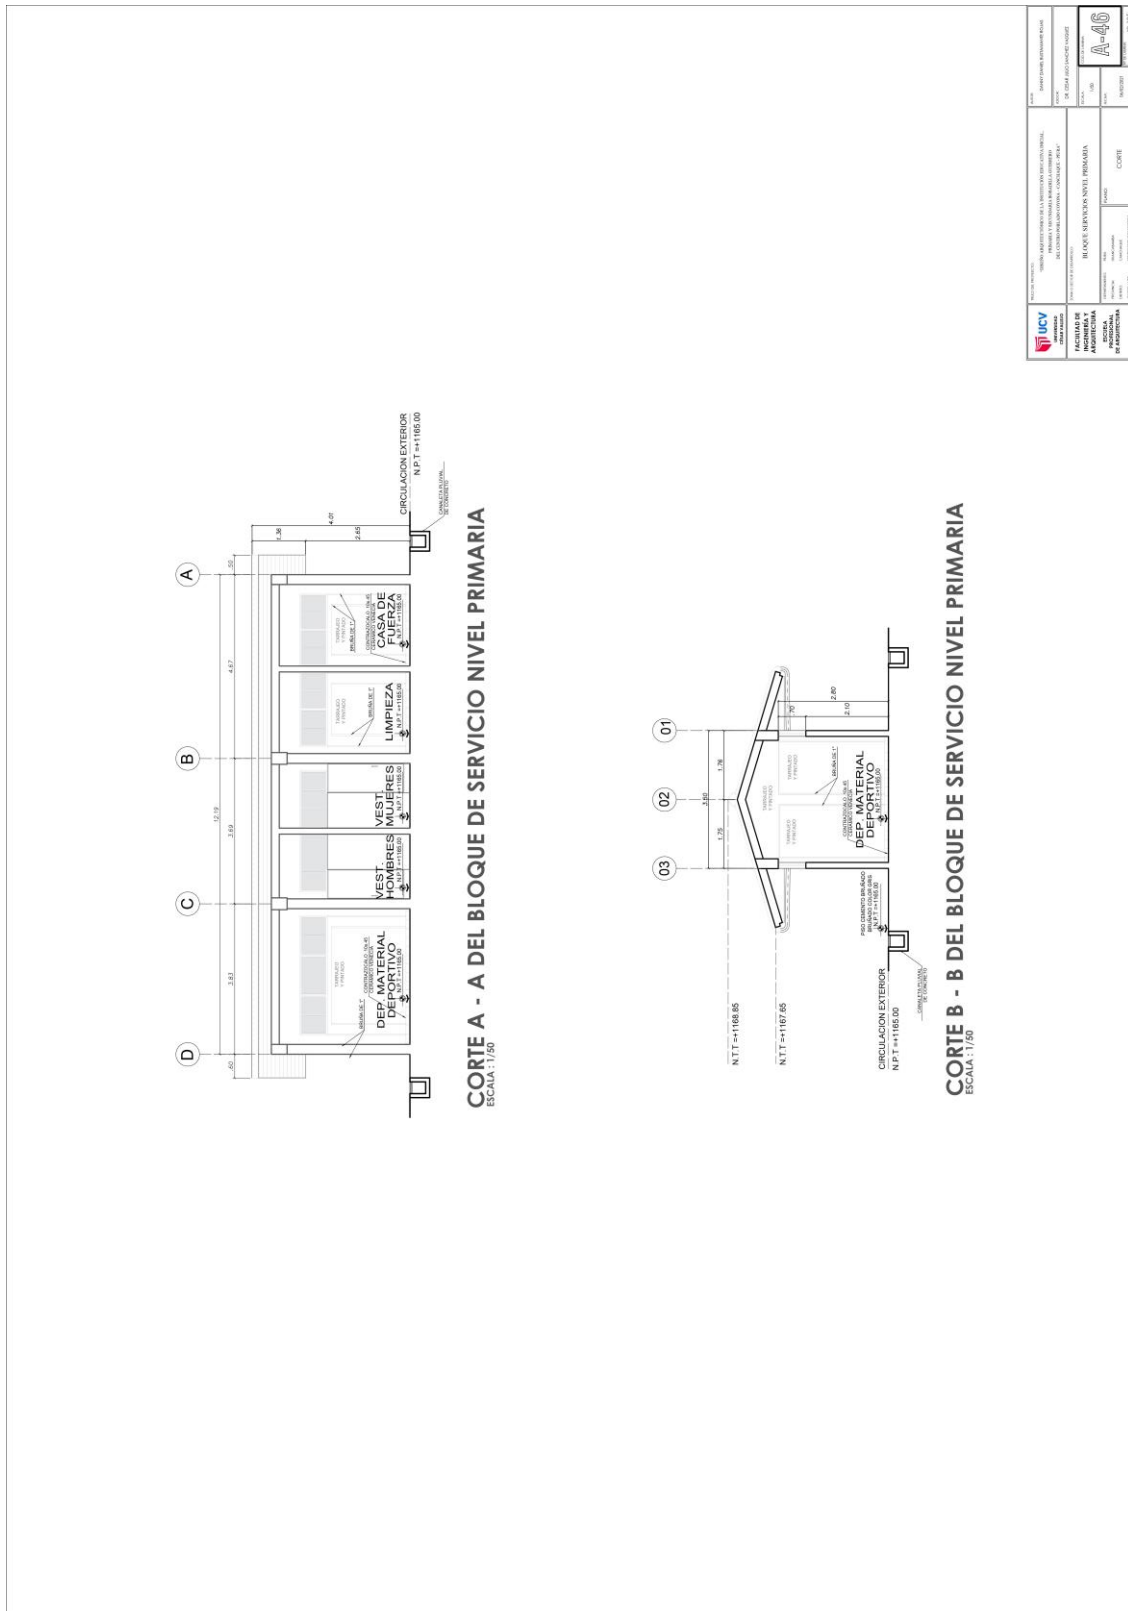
PLANO CORTE SSHH NIVEL PRIMARIA
